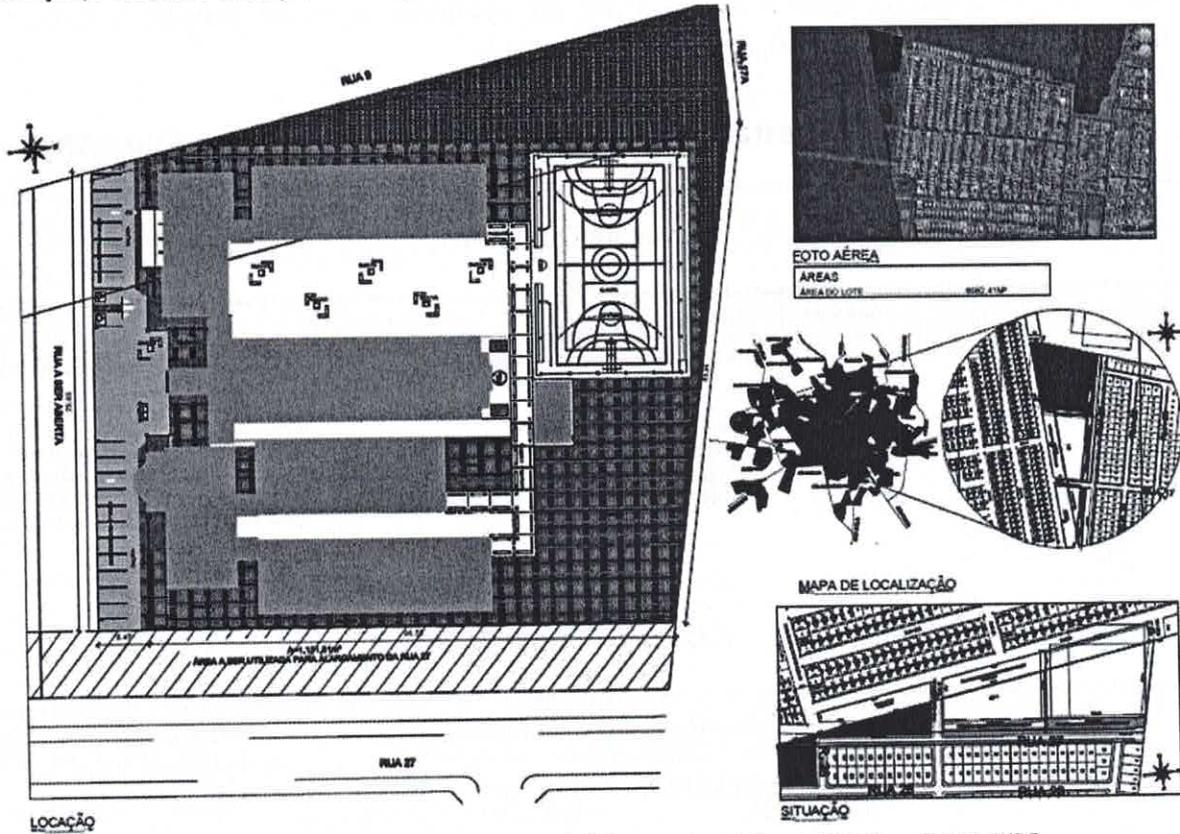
Exemplo de "Planta de Locação" de uma obra de Escola 12 Salas - Projeto FNDE.
